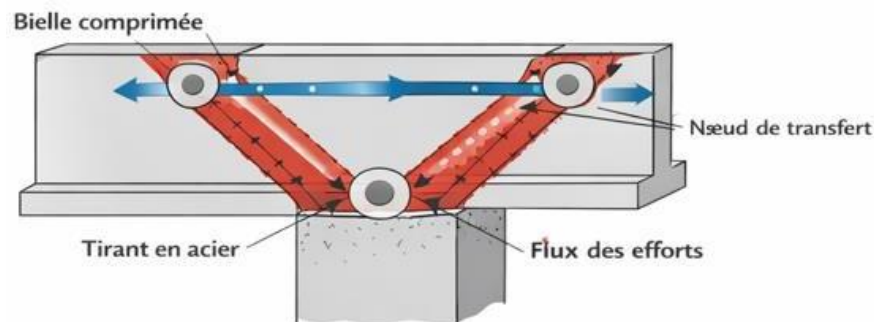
Modélisation bielle-tirant d'un assemblage poutre-poteau selon le fib Model Code.
